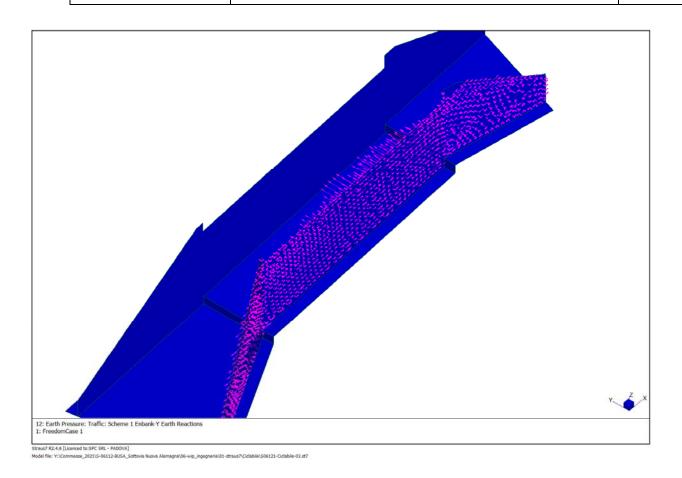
Azioni sulla parete -Y del manufatto determinate dalle reazioni vincolari del sottomodello del volume di terreno a tergo del muro sottoposto alle azioni di traffico veicolare di schema 1
